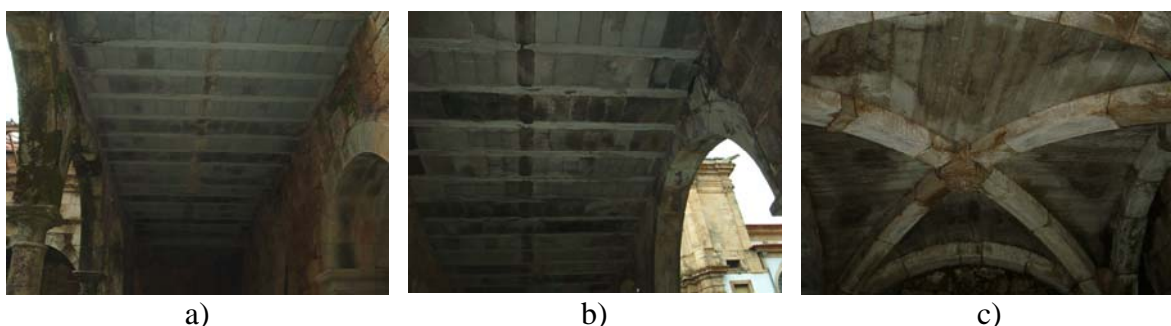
a) e b) Laje aligeirada de consolidação do claustro pequeno, com incorporação de tirantes; c) Abóbada nervurada em betão armado
